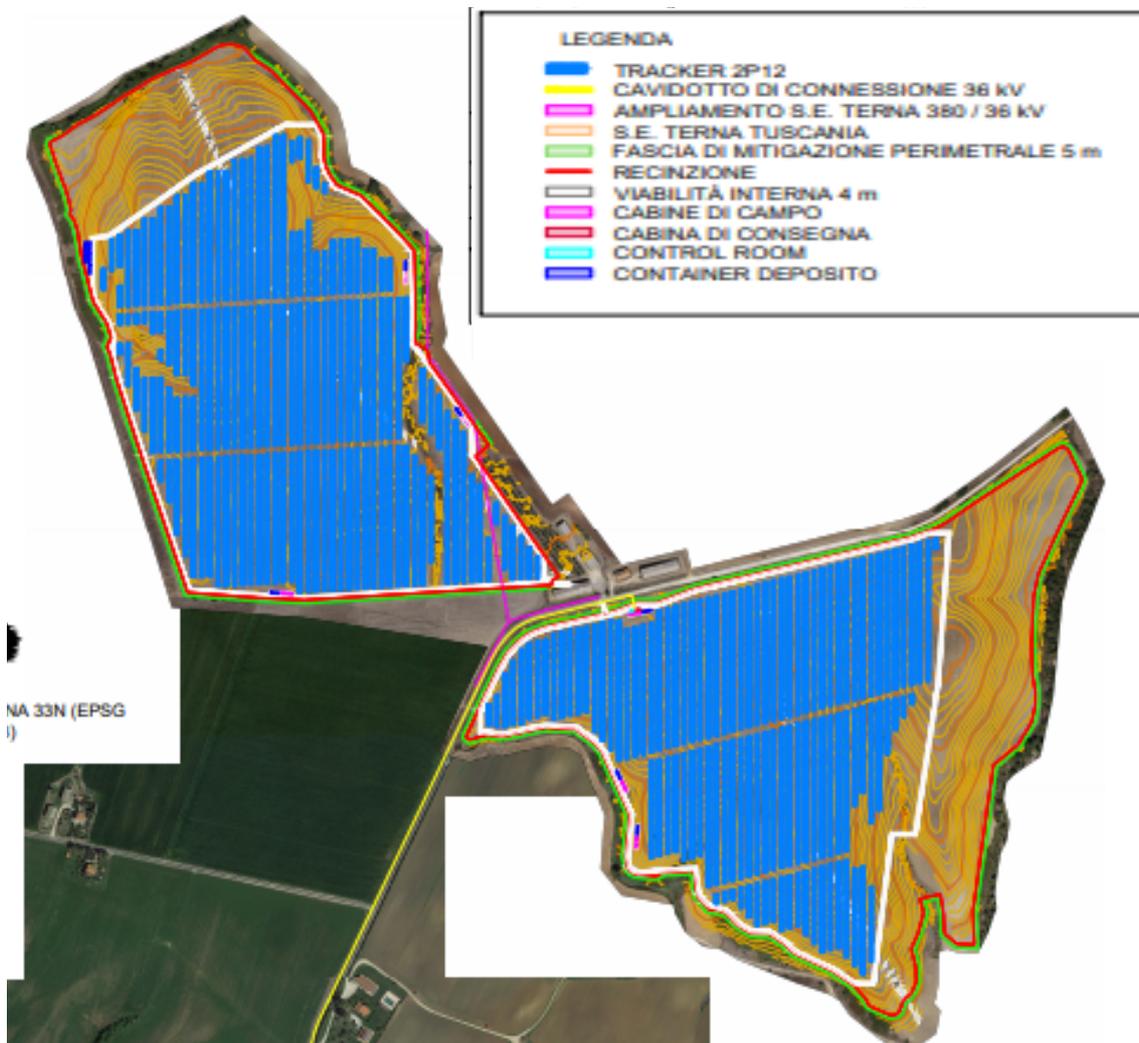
Layout impinato con indicazione delle fasce perimetrali e di mitigazione
